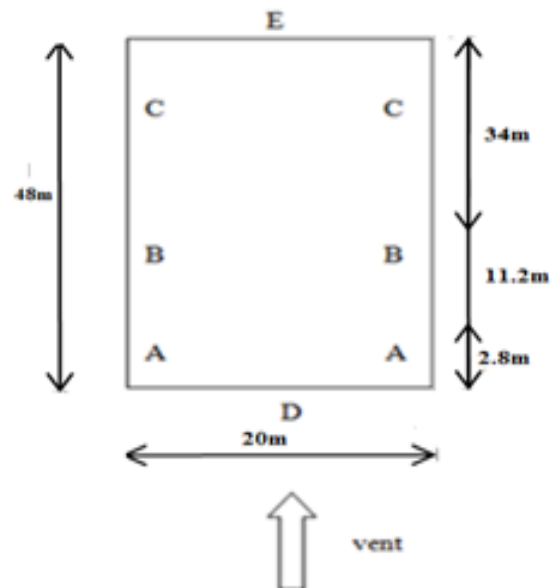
Vue en plan des zones de pression sur les parois verticales suivant le pignon
